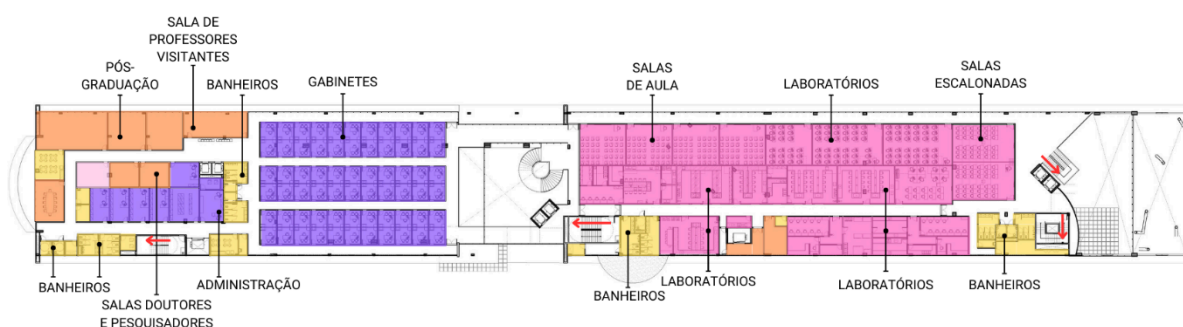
Planta setORIZADA do segundo pavimento. Fonte: Acervo UFC.
